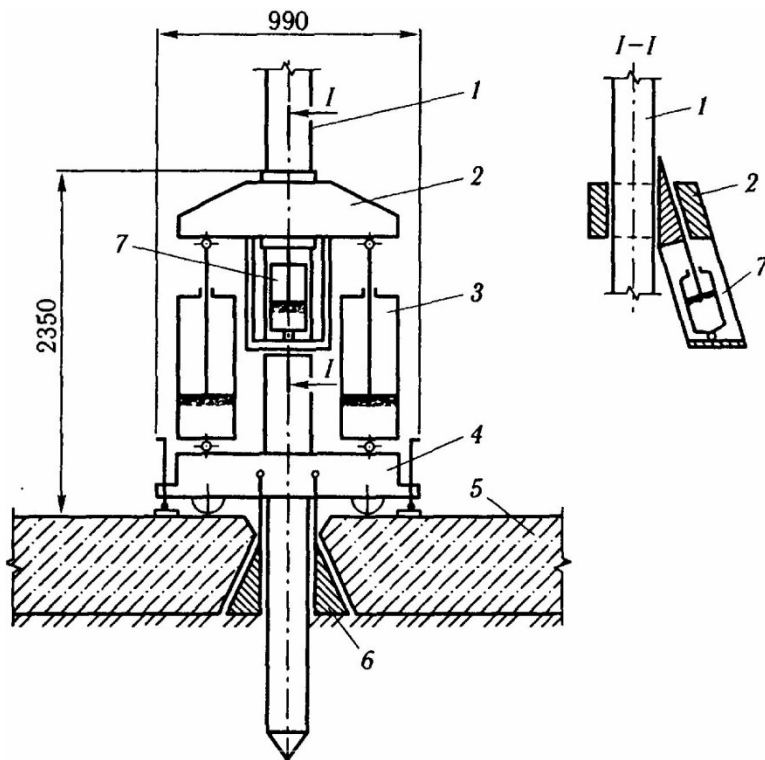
Гідралічний вдавлювач палі: 1 - паля; 2 - рухома обойма; 3 - робочий гідроциліндр; 4 - рама; 5 - ростверк; 6 - анкер; 7 - гідроциліндр клинового затискача
